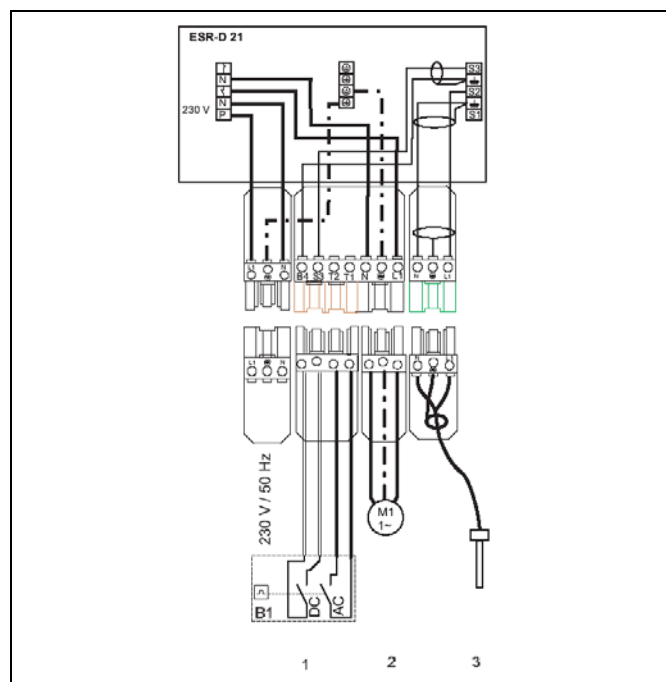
Planul de cablare pentru reglarea turației REHAU
